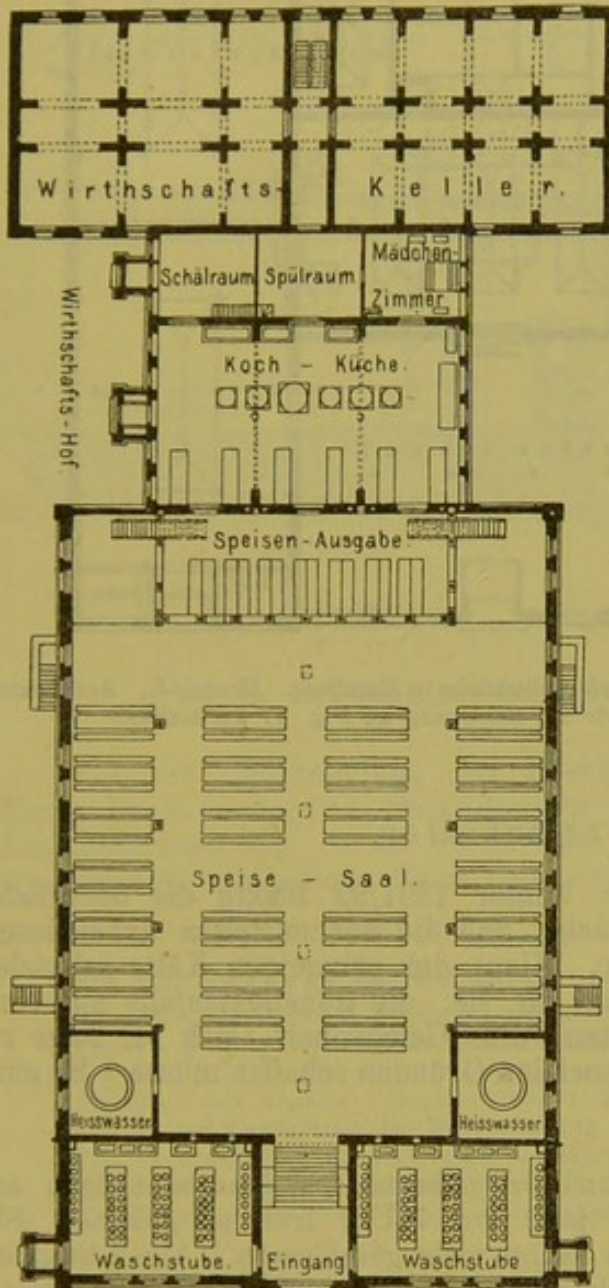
Kosthaus des Bochumer Vereins für Bergbau und Gußstahlfabrikation zu Stahlhausen. Grundriß.
